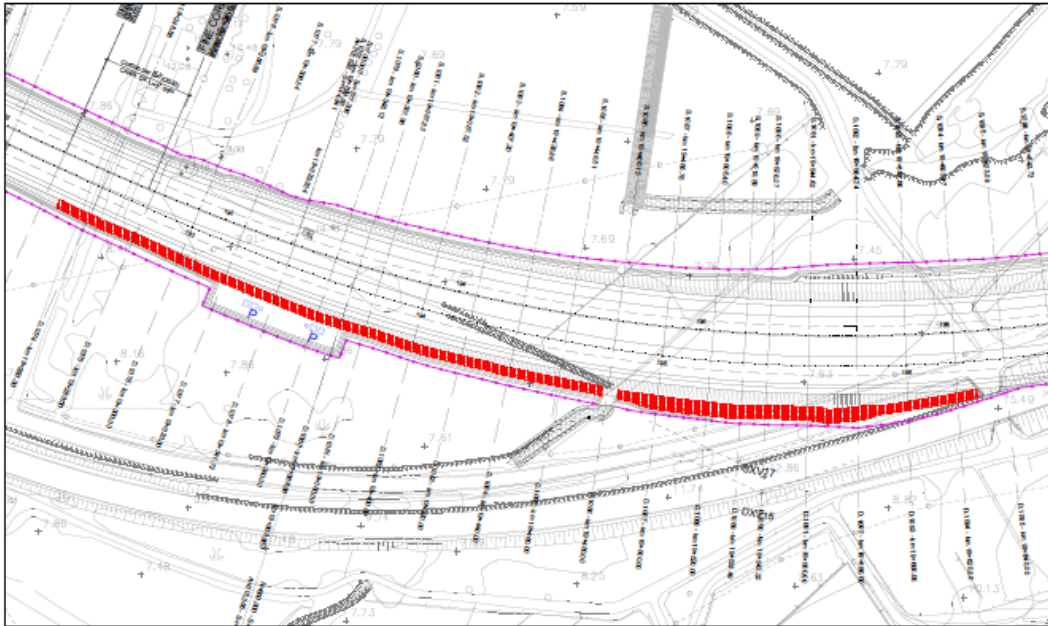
protezione rilevato da km 19+245 a km 19+628.
